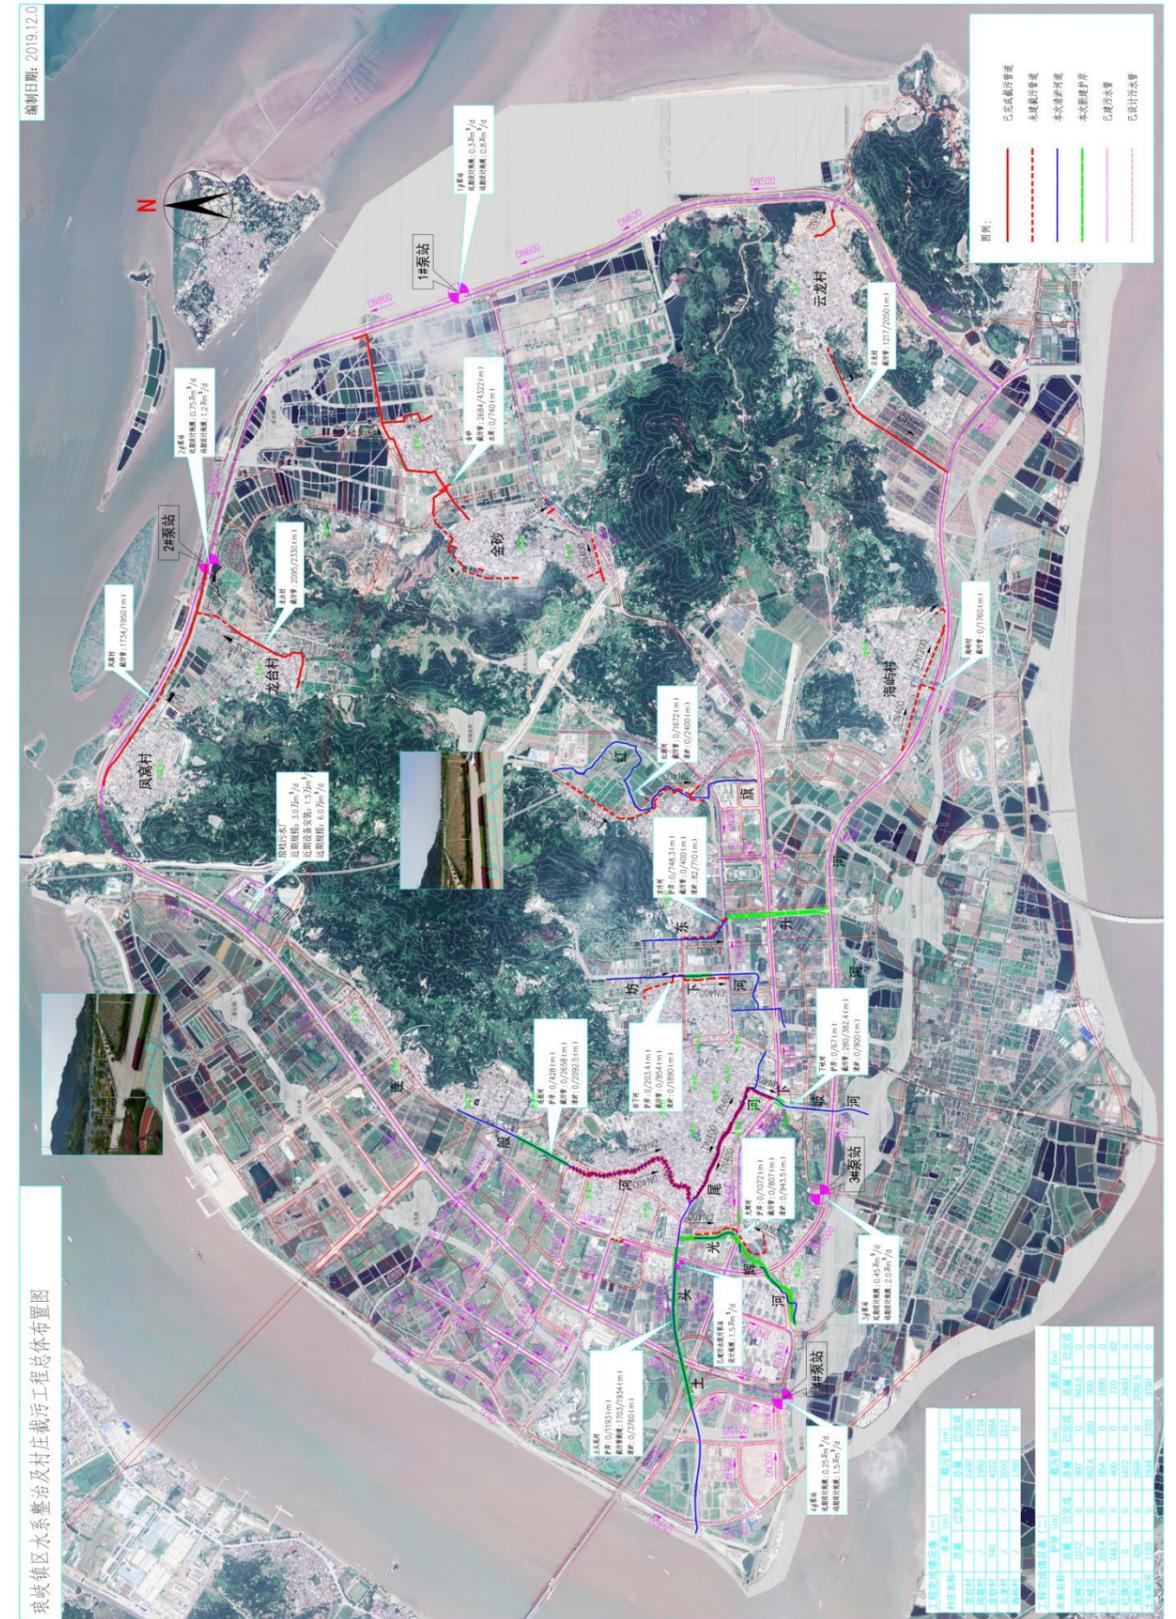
琅岐污水处理厂截污管网总平面布置图
